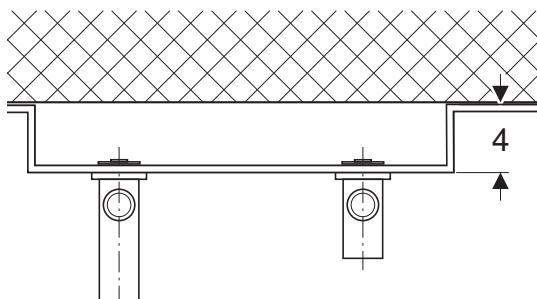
Монтажные размеры для наружного монтажа с использованием ступенчатой монтажной панели Geberit
